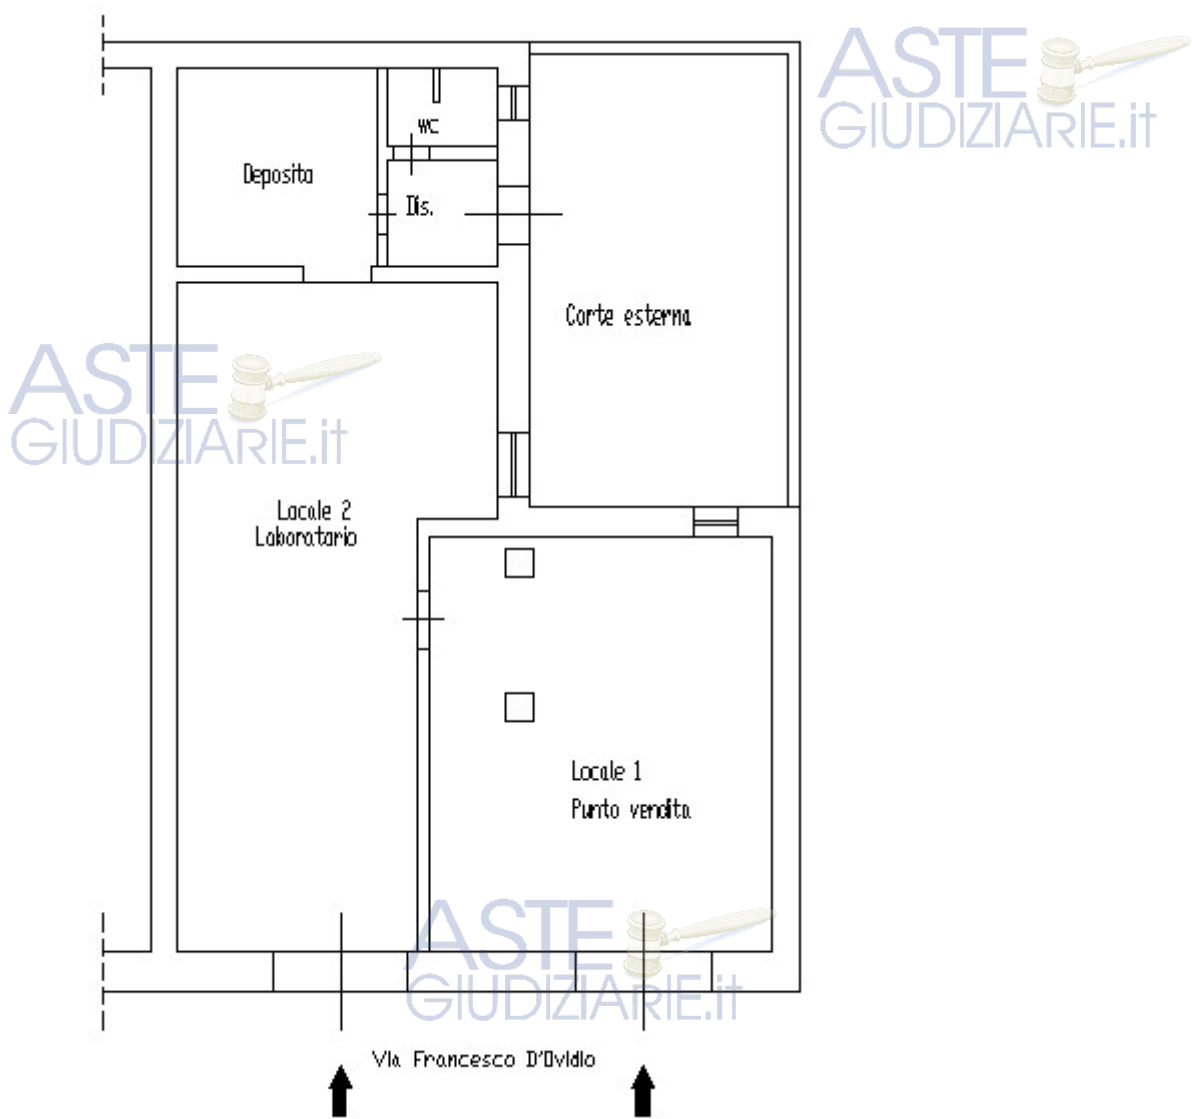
Planimetria del locale commerciale oggetto di pignoramento
